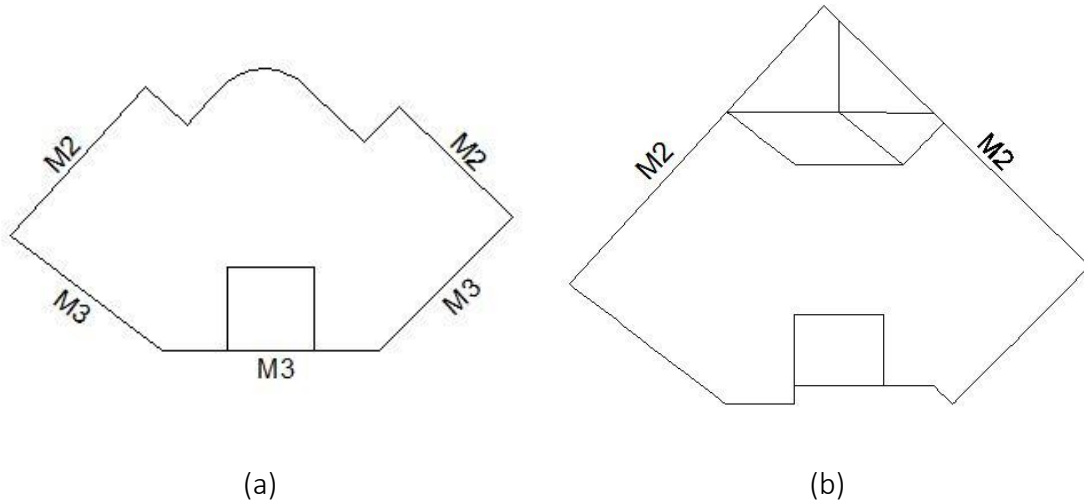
Muros de contenção – (a) Sub-cave; (b) Cave
